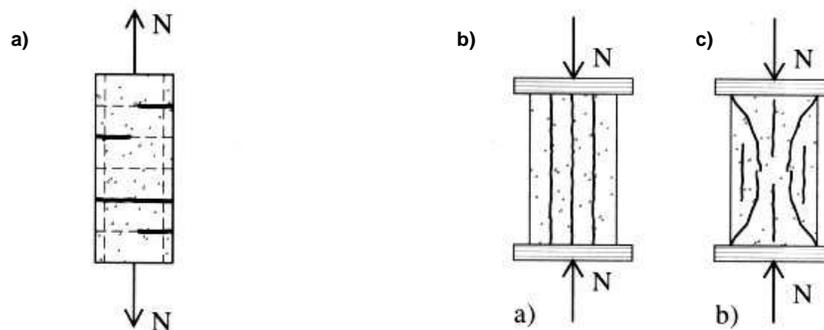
Representação esquemática da fissuração devido ao esforço de tração e compressão (CÁNOVAS, 1988).
